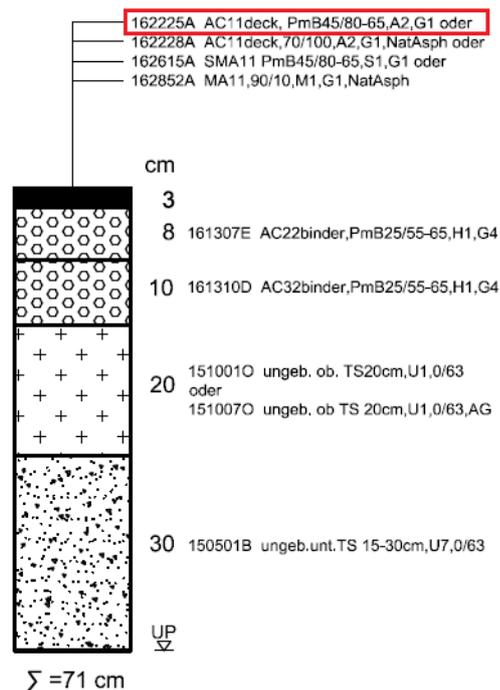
Regelaufbau einer Asphaltkonstruktion LK 10 (71cm) (42)
